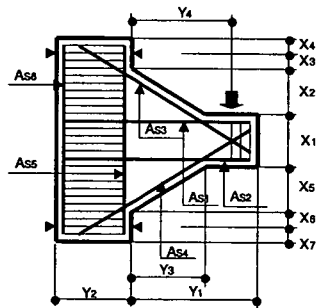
試験体の形状と配筋状況 (TYPE-IV①)
